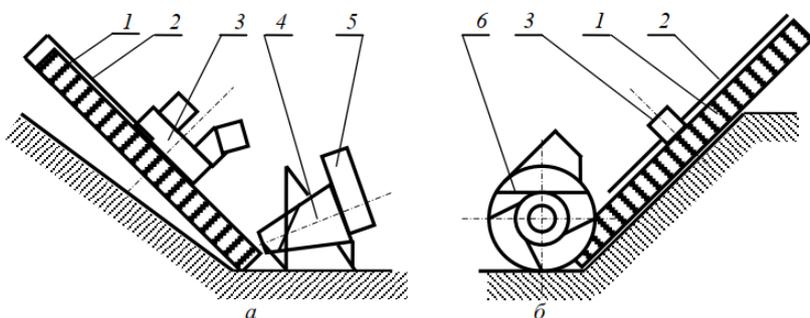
Схема комбинированных рабочих органов: а — шнекофрезерного с коническим шнеком; б — двухфрезерного; 1 — фрезерный рабочий орган с осью вращения, перпендикулярной откосу; 2 — кожух; 3 — привод фрезы; 4 — шнековый рабочий орган с осью вращения, перпендикулярной откосу; 5 — привод шнека; 6 — фрезерный рабочий орган с осью вращения, параллельной оси канала
